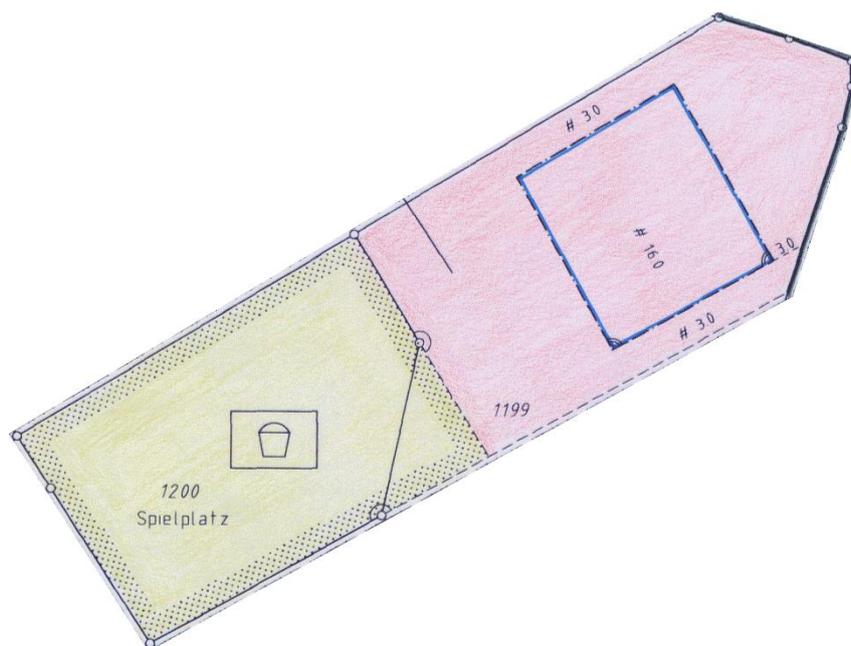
Auszug aus dem Bebauungsplan Wa/8a, 2. Änderung
